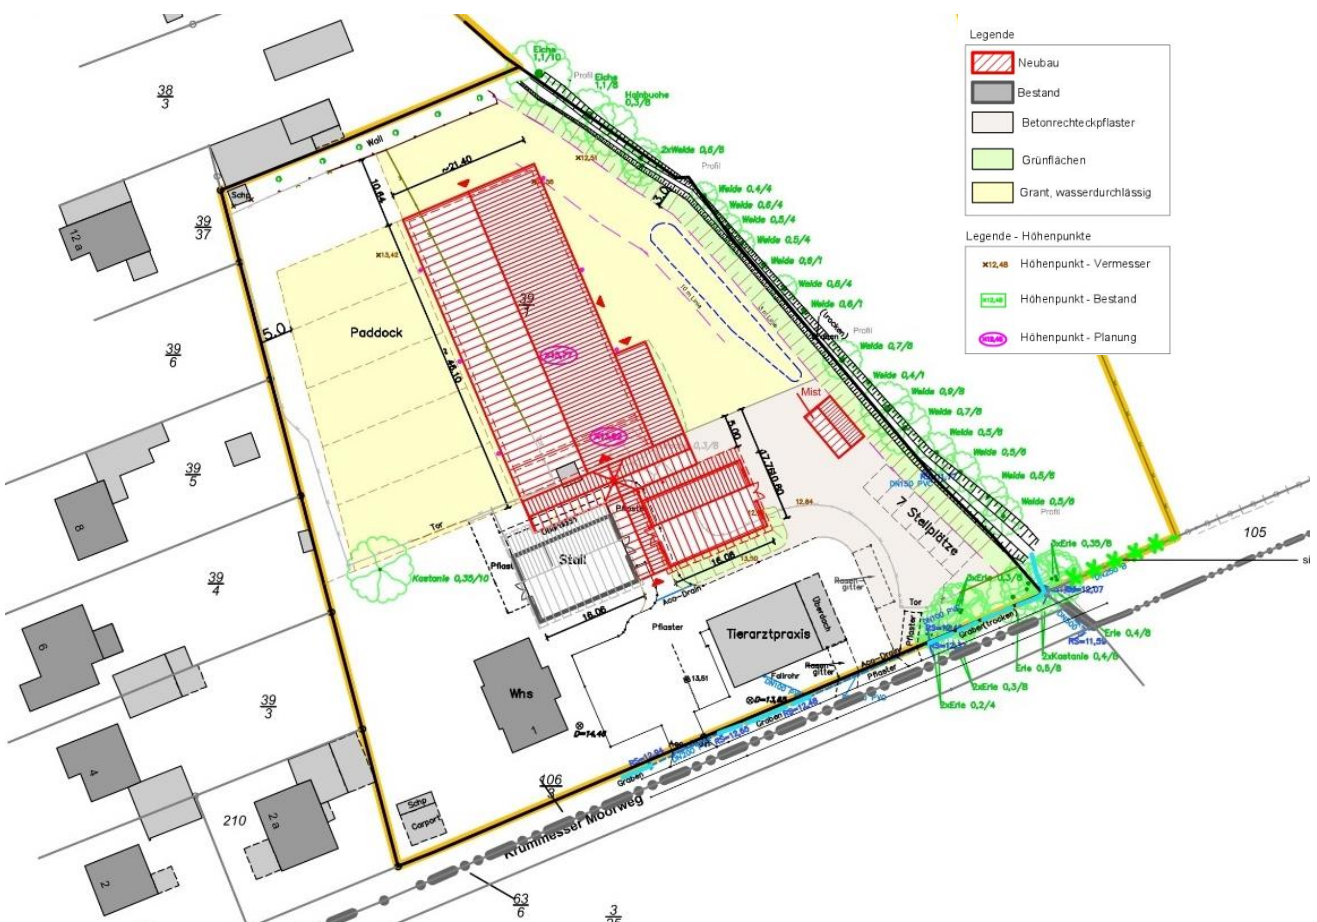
Auszug aus dem Lageplan des beauftragten Architekturbüros/Ingenieurbüro R. Petereit
